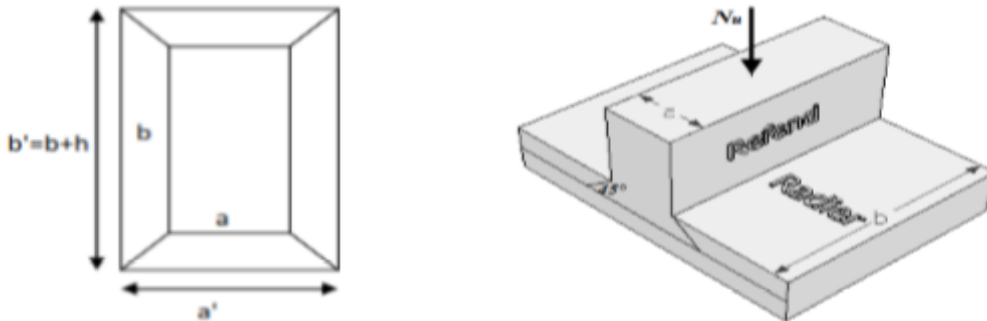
Périmètre utile des voiles et des poteaux.
